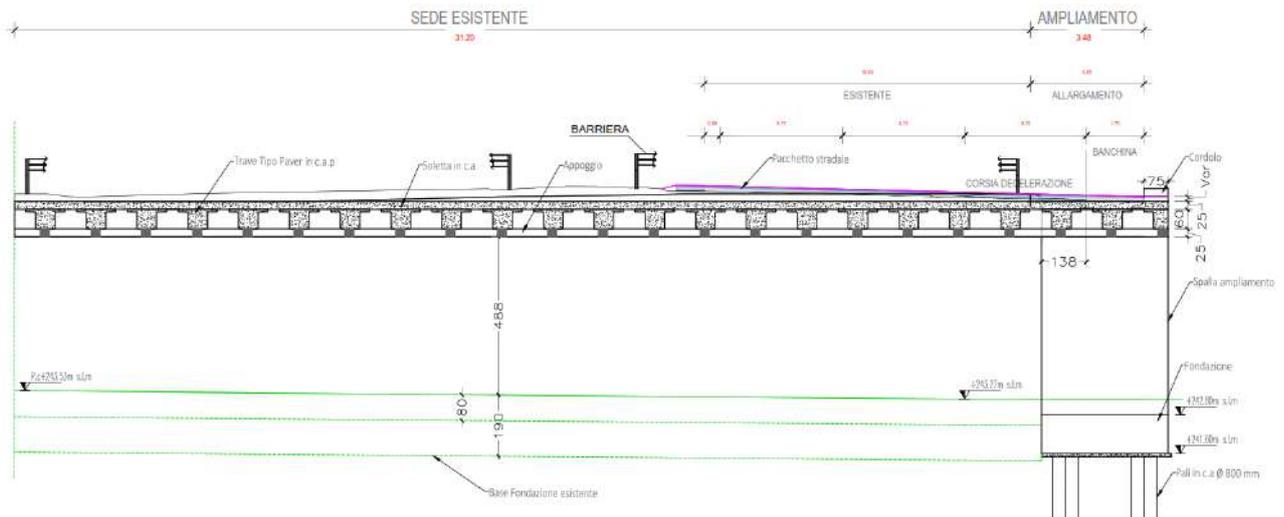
Sezione longitudinale nuovo impalcato di Veduggio
